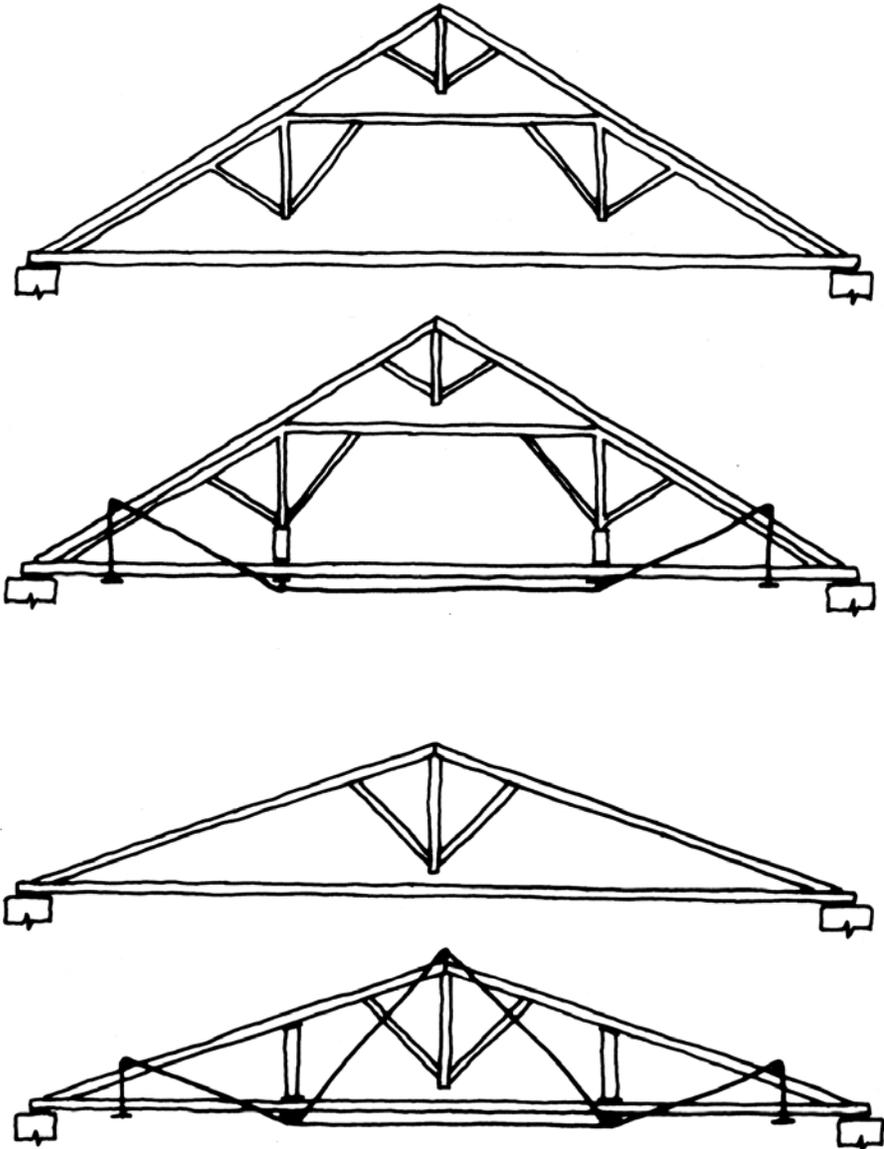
Refuerzo de armaduras de cubierta mediante el añadido de nuevas barras de acero.
